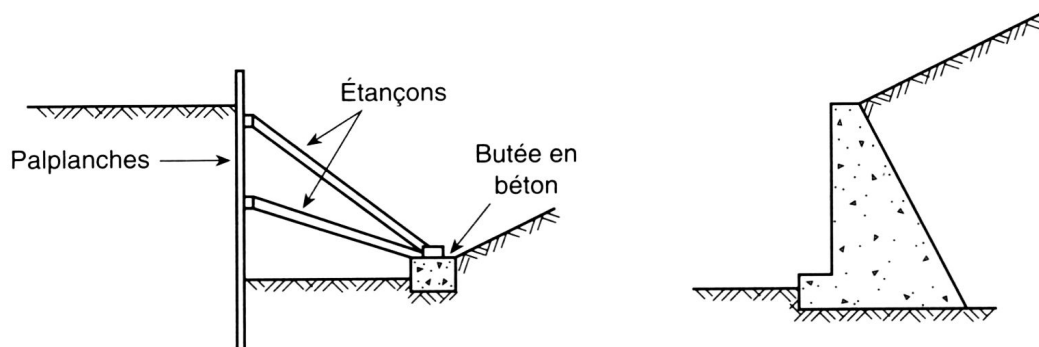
Ouvrages de soutènement : palplanches étançonnées à gauche et mur de soutènement en béton à droite.
